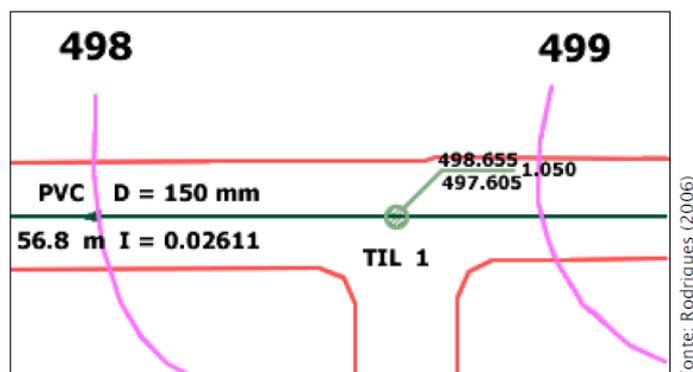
Representação de um TIL em uma planta de cálculo ou execução.
